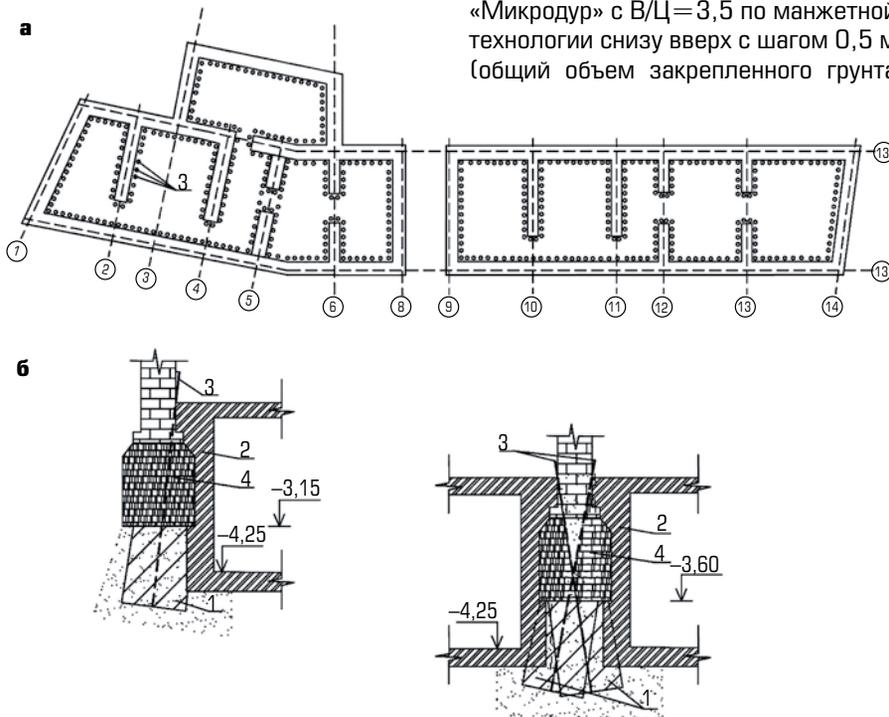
План подвала реконструируемого здания по Нижнему Кисловскому переулку (Москва): а — план подвала; б — схема укрепления грунтов: 1 — закрепленный грунт; 2 — новые конструкции подвала; 3 — манжетные колонны; 4 — бутобетонная кладка фундамента
